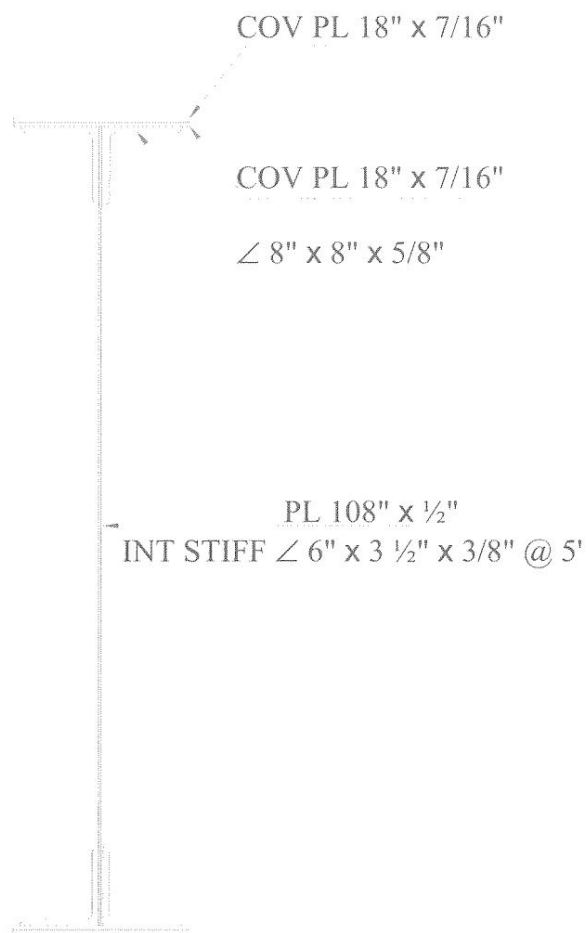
Sección transversal de viga en la mitad del claro
